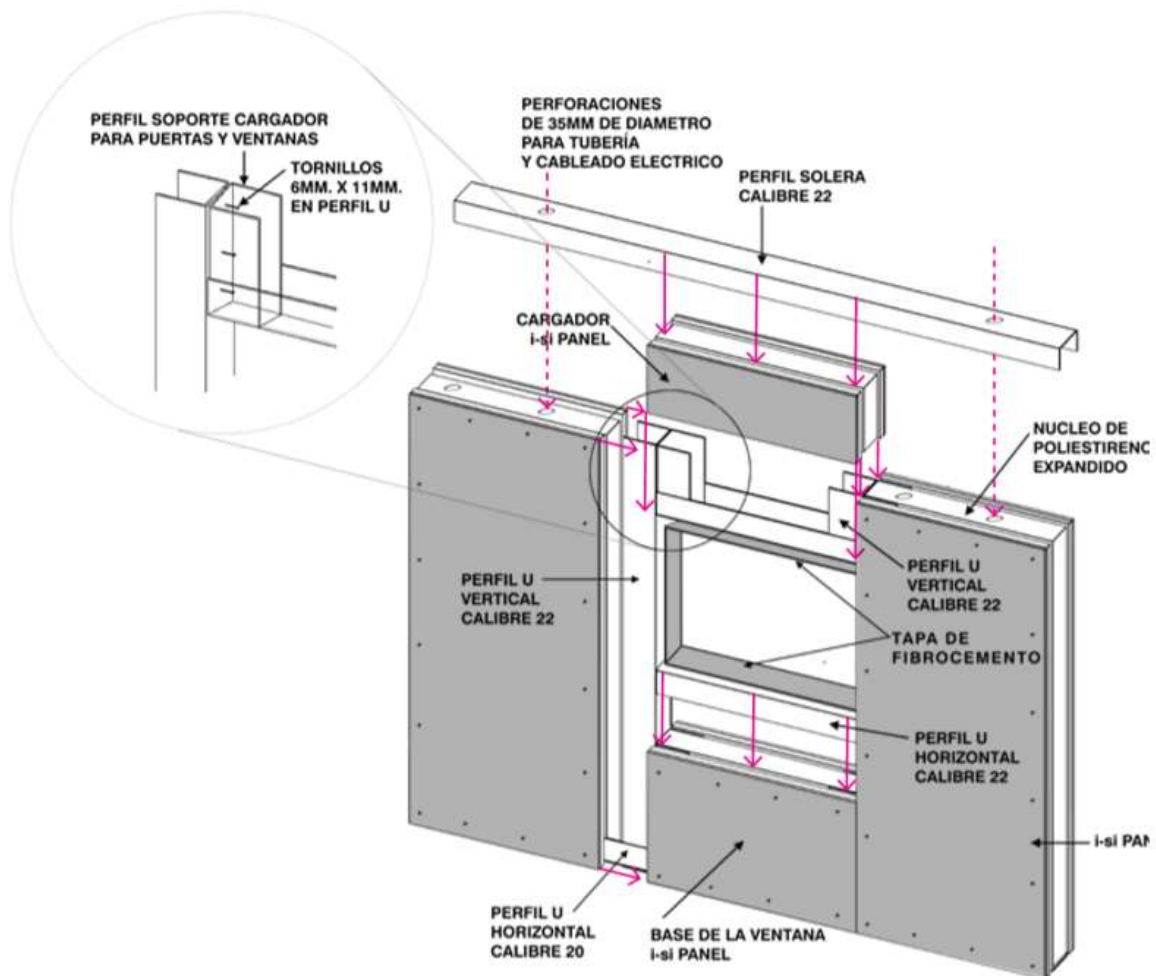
Unión entre paneles de pared y paneles tipo cargador para puertas y ventanas - Panacor.
